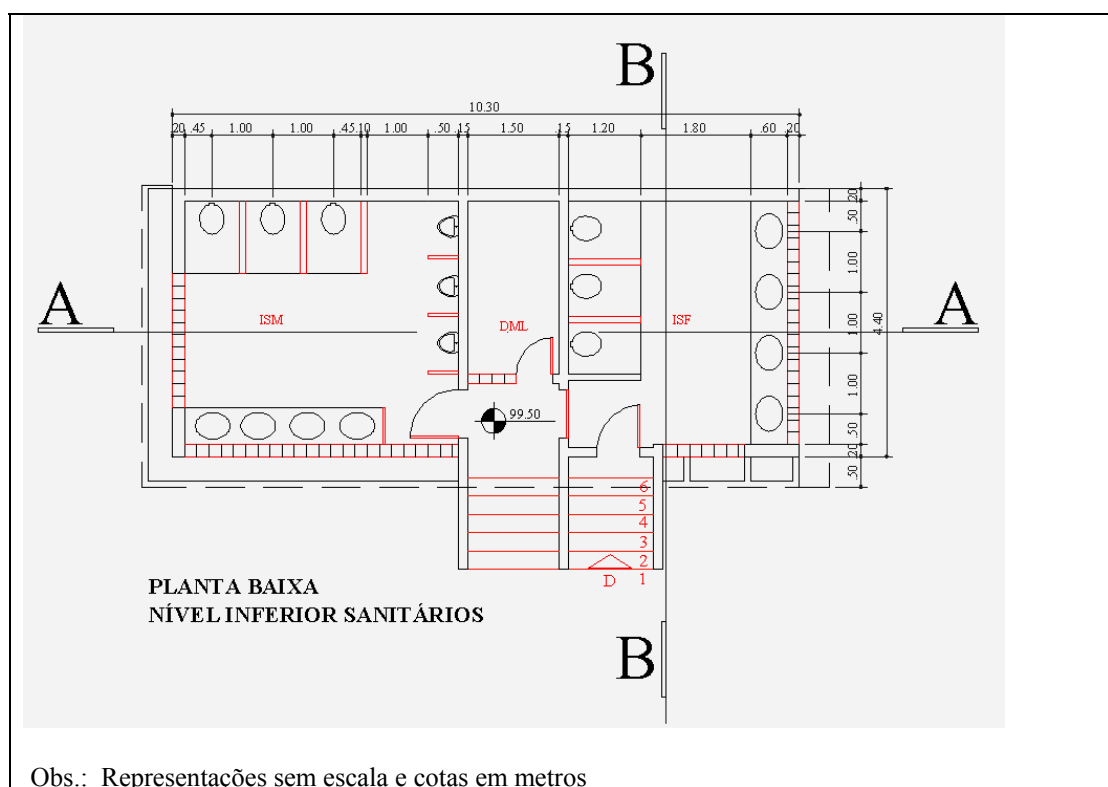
Planta baixa do Edifício Pedra nível inferior
